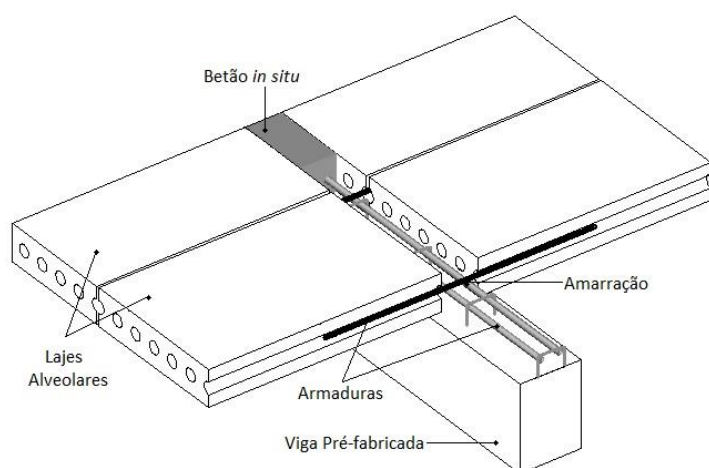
Ligação Laje – Viga central com amarração com betonagem *in situ
